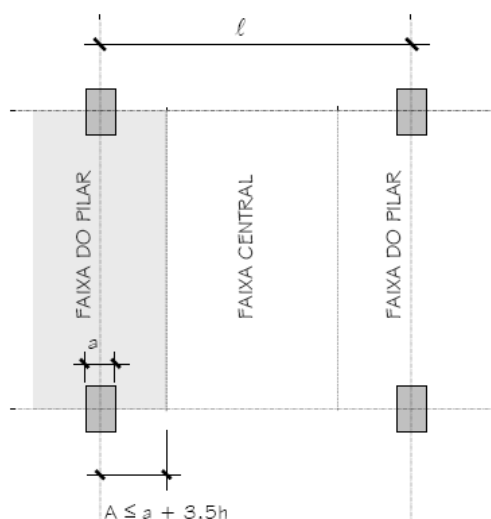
Largura recomendável para distribuição dos cabos na região dos pilares – Fonte: EMERICK
